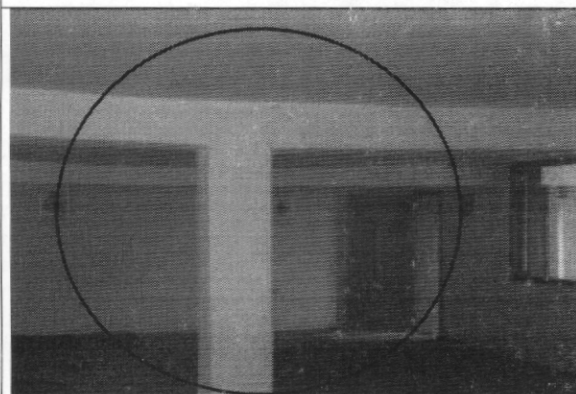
Deflexión en vigas y asentamiento de columnas centrales
